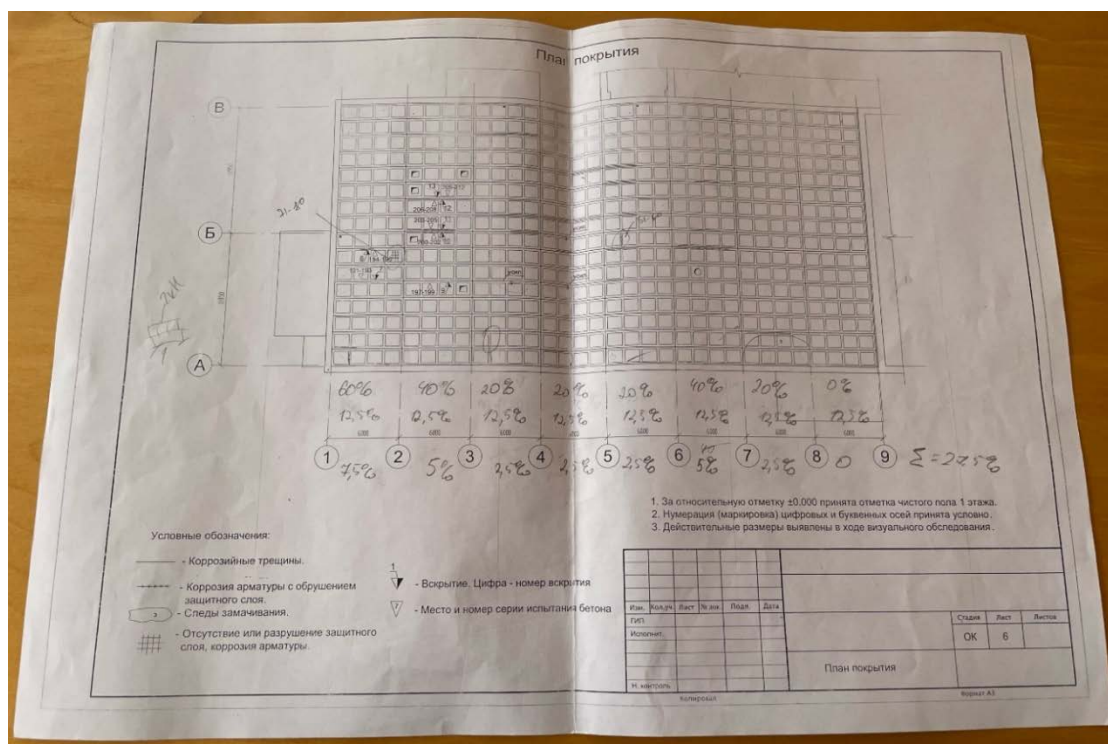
План покрытия жилого дома по адресу г. Киров, ул. Грибоедова, д. 30 с повреждениями (дефектами) (авторская разработка)
